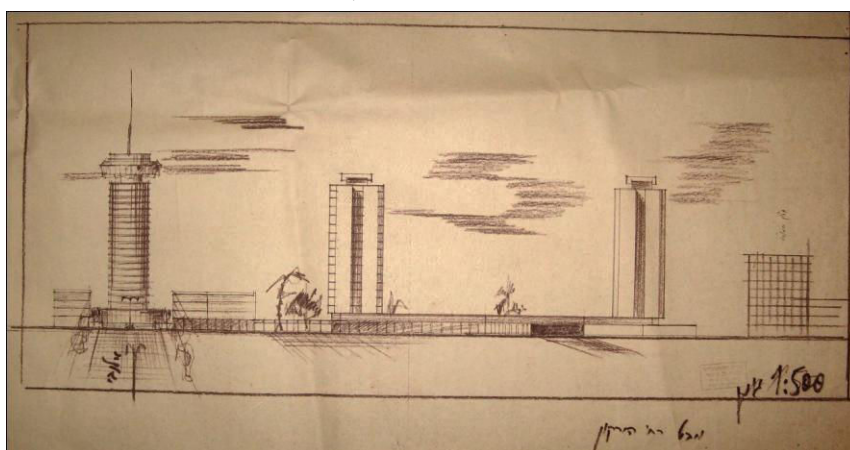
La ville en mégastructures: des tours au long de la plage : façades.
